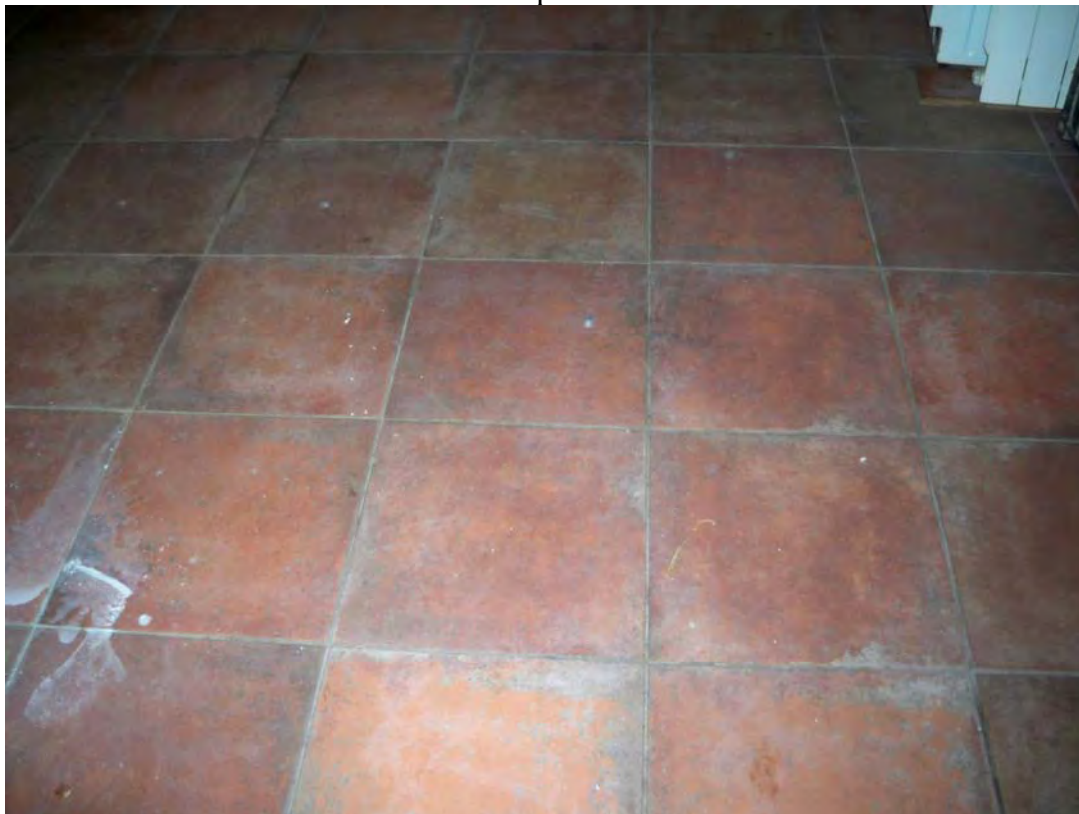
Ingresso garage via Brenta 7A - “Lotto 3”
